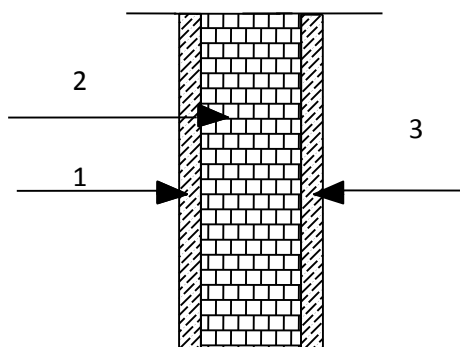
Coupe transversale du mur intérieure (brique de 10cm d'épais
